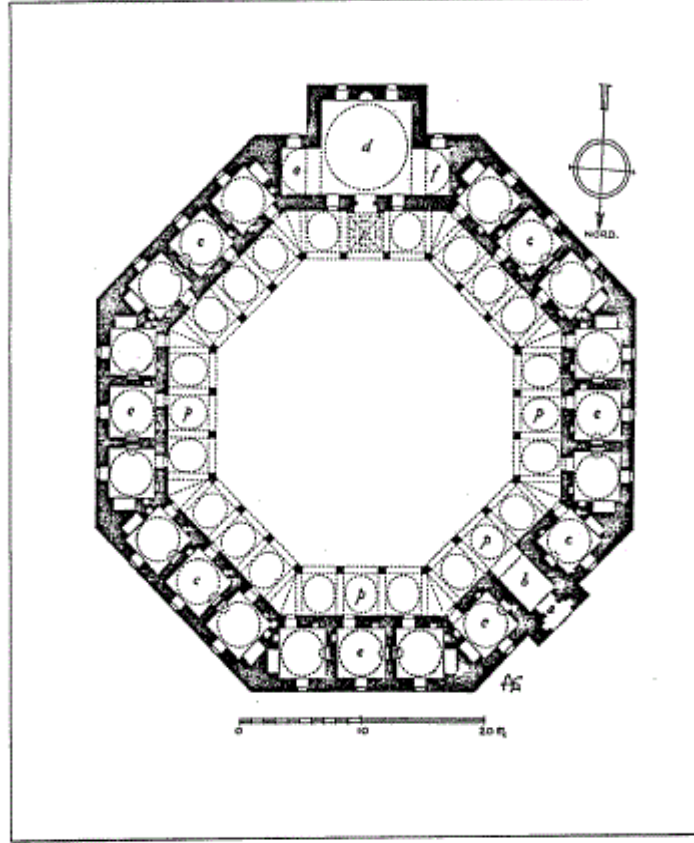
مسقط أفقي لمدرسة الصدر الأعظم قوجه سنان باشا في استانبول
